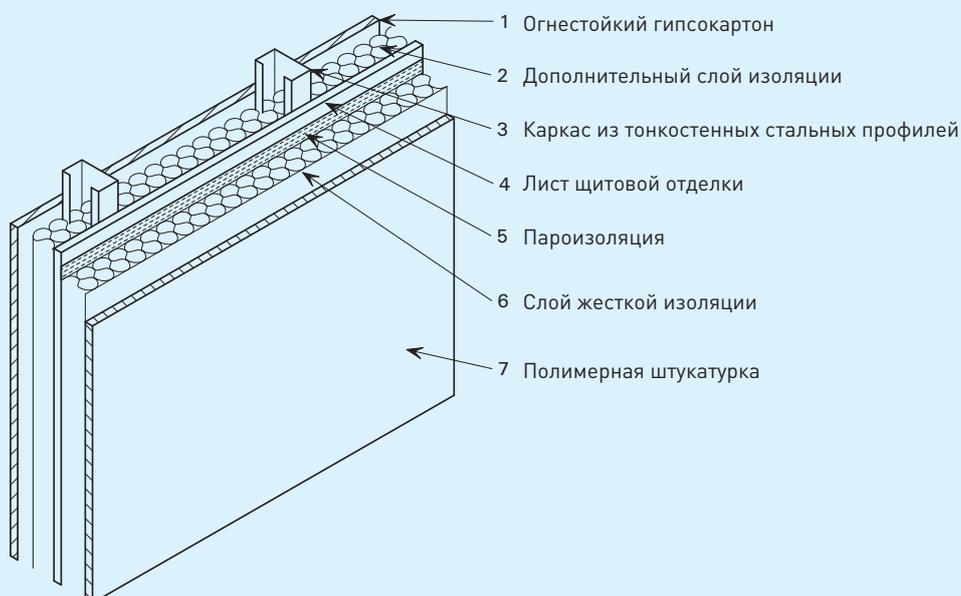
Типовая фасадная конструкция со штукатуркой по утеплителю на легком стальном каркасе
